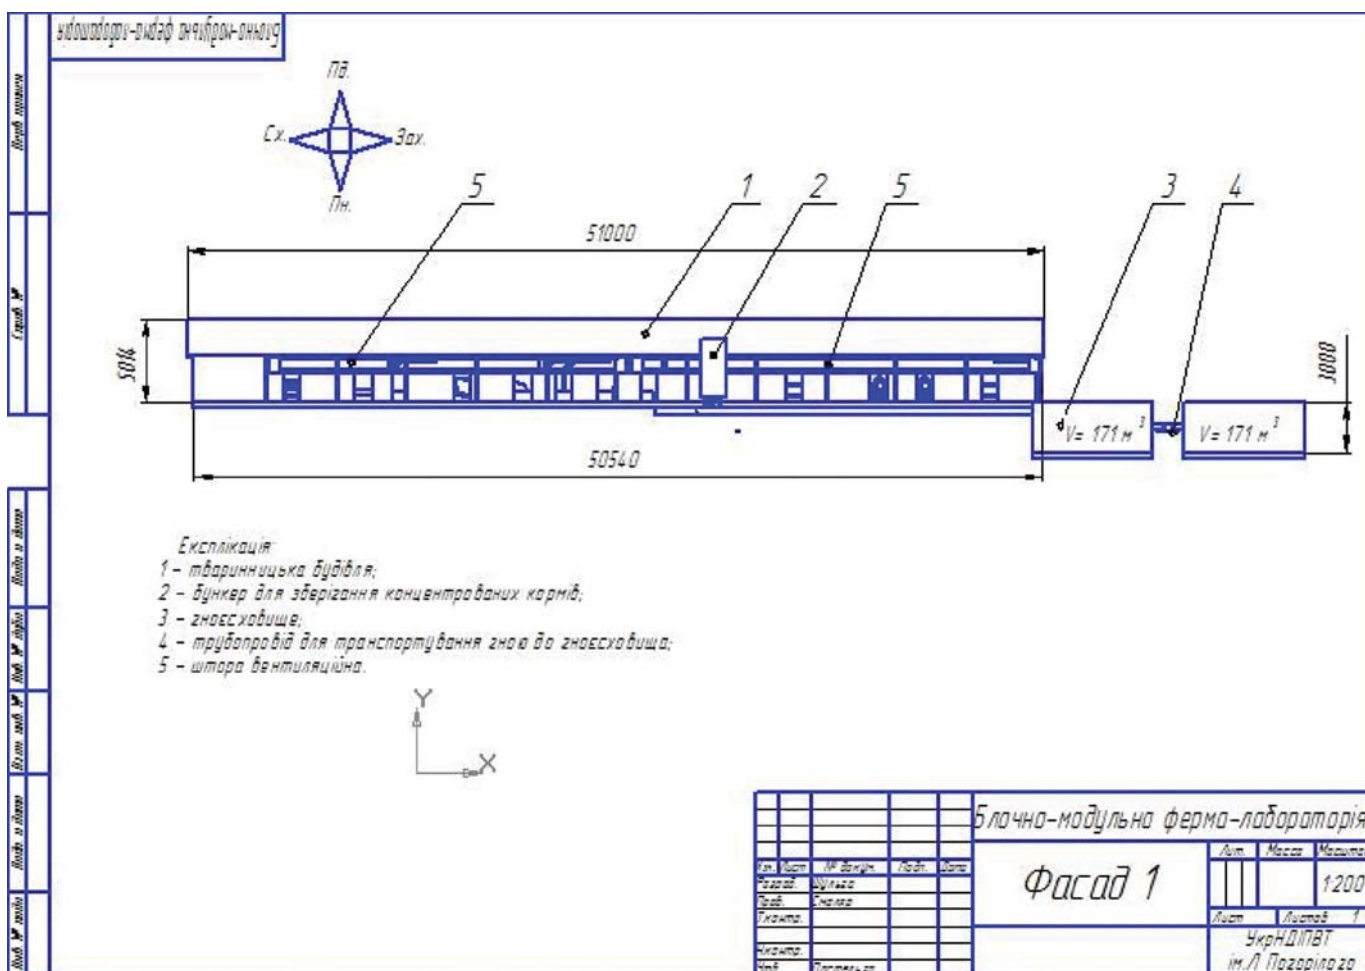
Фасад блочно-модульної ферми на 100 голів тварин
